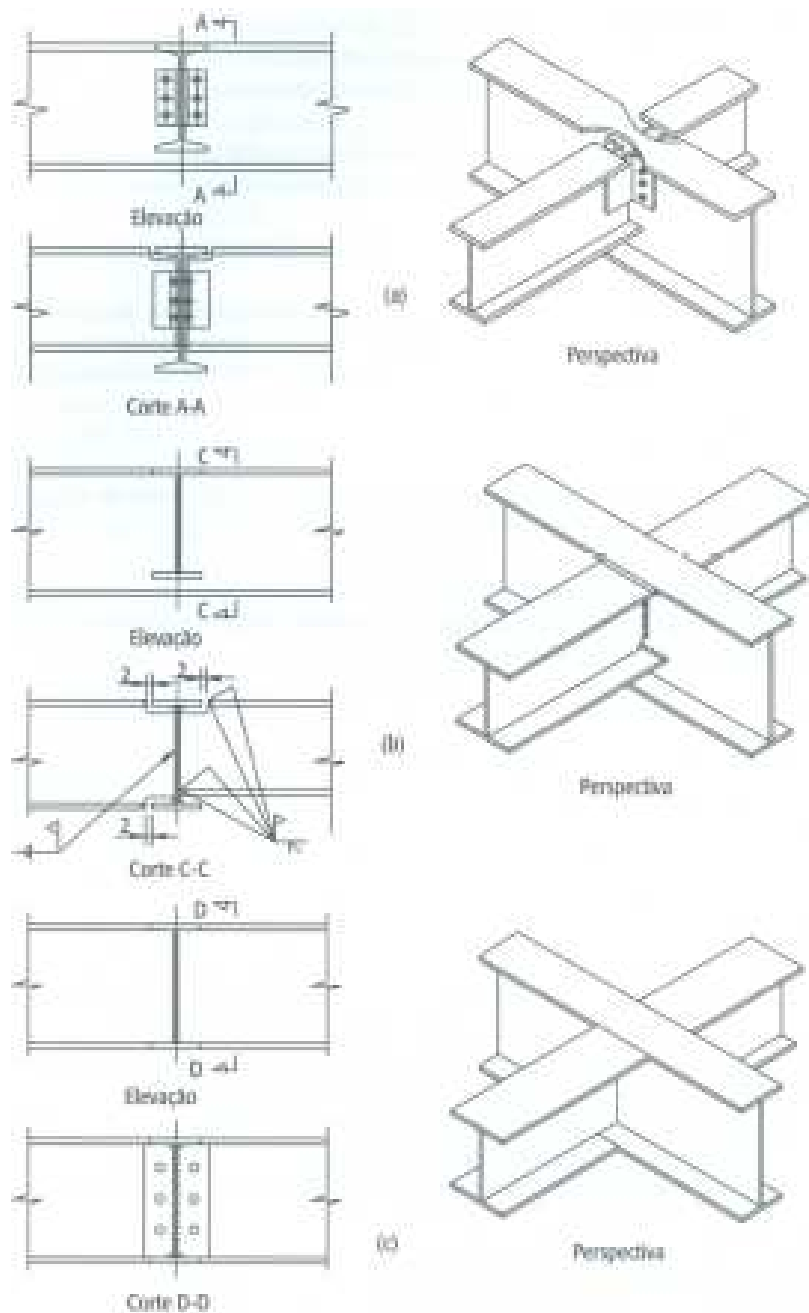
Ligações viga-viga (fonte: Bellei 1986).
